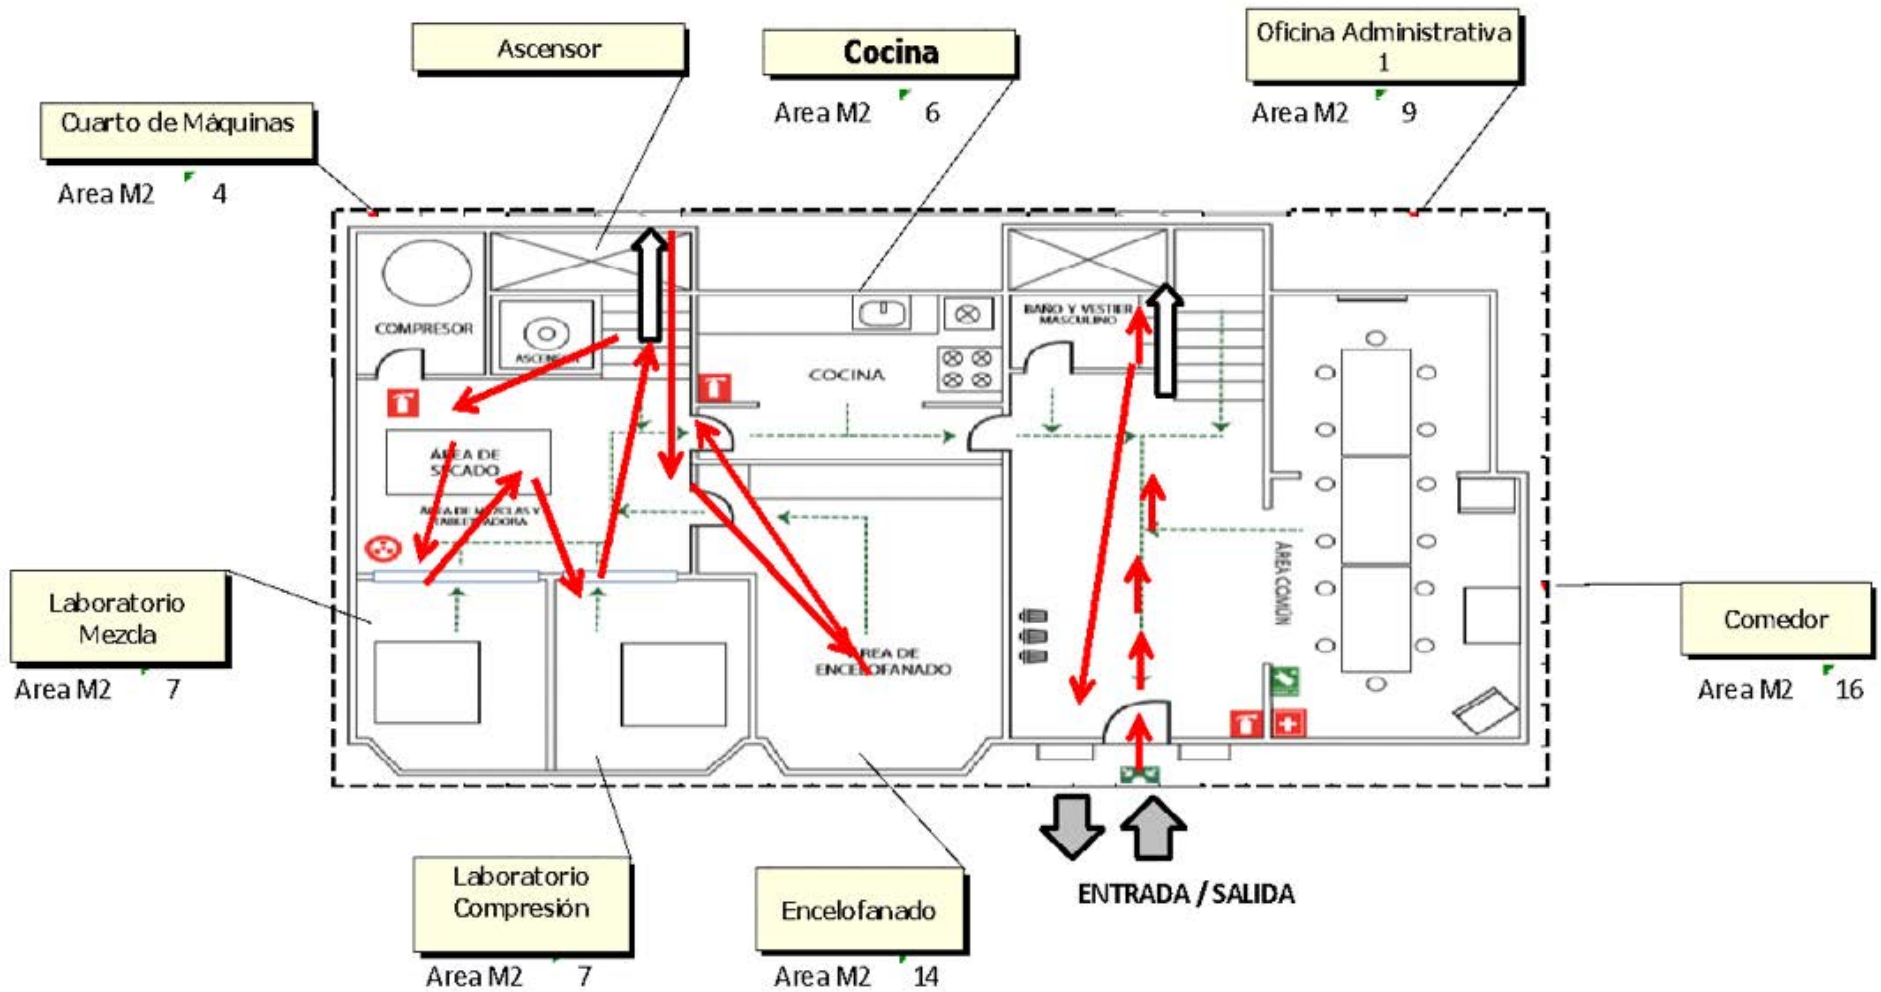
Planta 1. Laboratorio farmacéutico por áreas y recorridos
